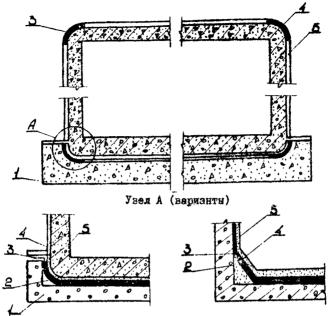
Устройство гидроизоляции подземных сооружений І-железобетонная стенка; 2-бетонная фаска или набетонка; 3-стеклоткань (стеклохолст), пропитанная мастикой; 4-гидроизоляция полимеройтумной мастикой; 5-защитная стенка или полимерцементная стяжка
